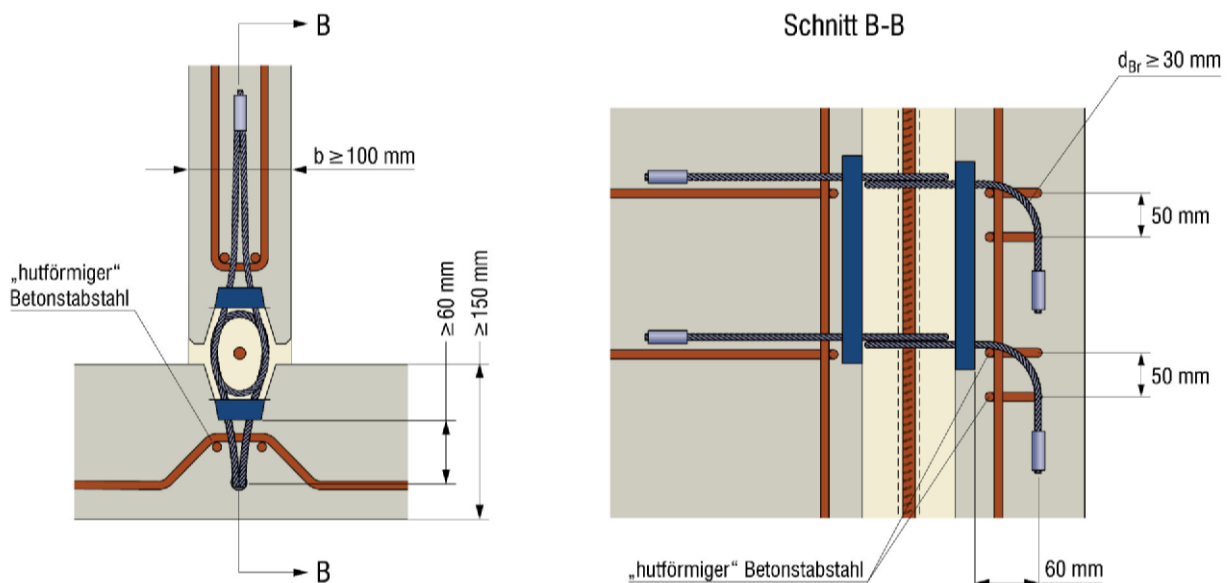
Wand – Wand – T-Verbindung - Detail mit abgewinkelten Seilschlaufen
